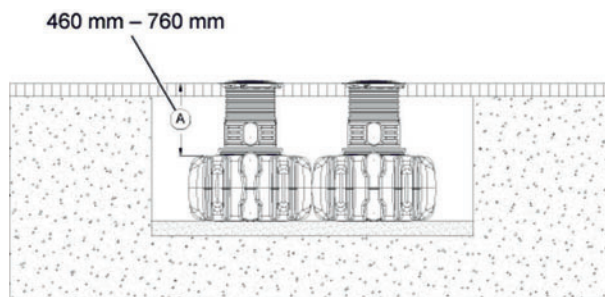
Hauteurs de recouvrement – Exemple FLAT
